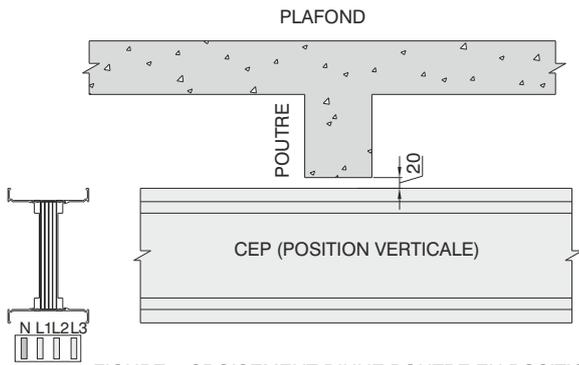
CROISEMENT D'UNE POUTRE EN POSITION VERTICALE
